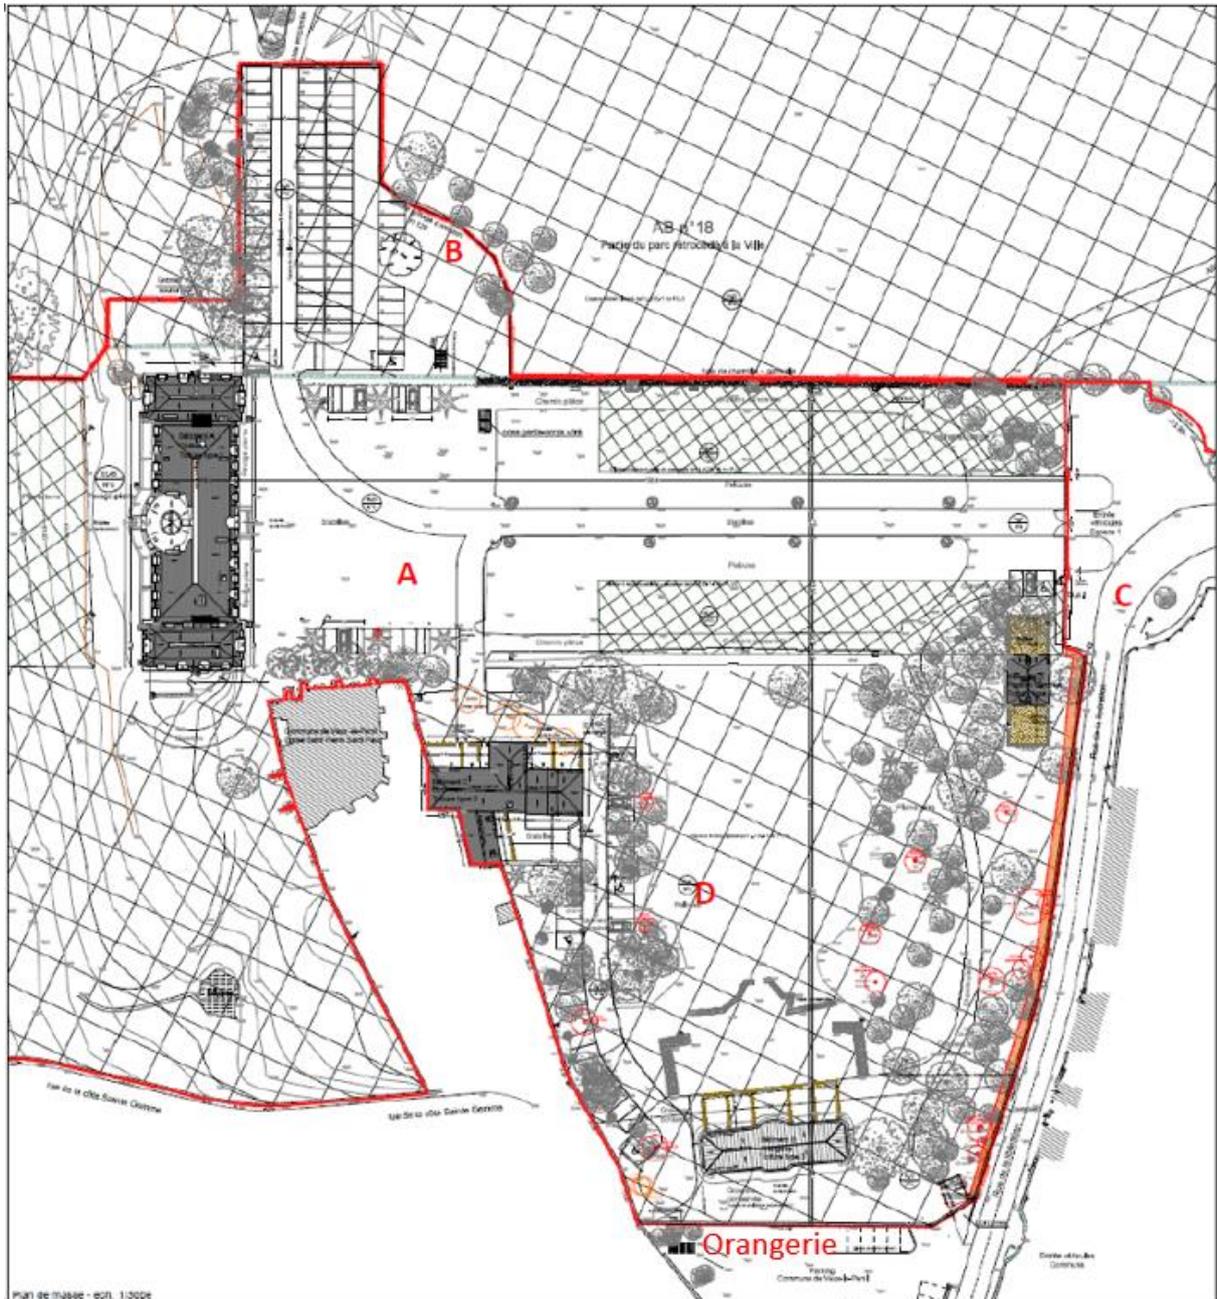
Localisation des constructions et éléments du paysage présents sur le site
